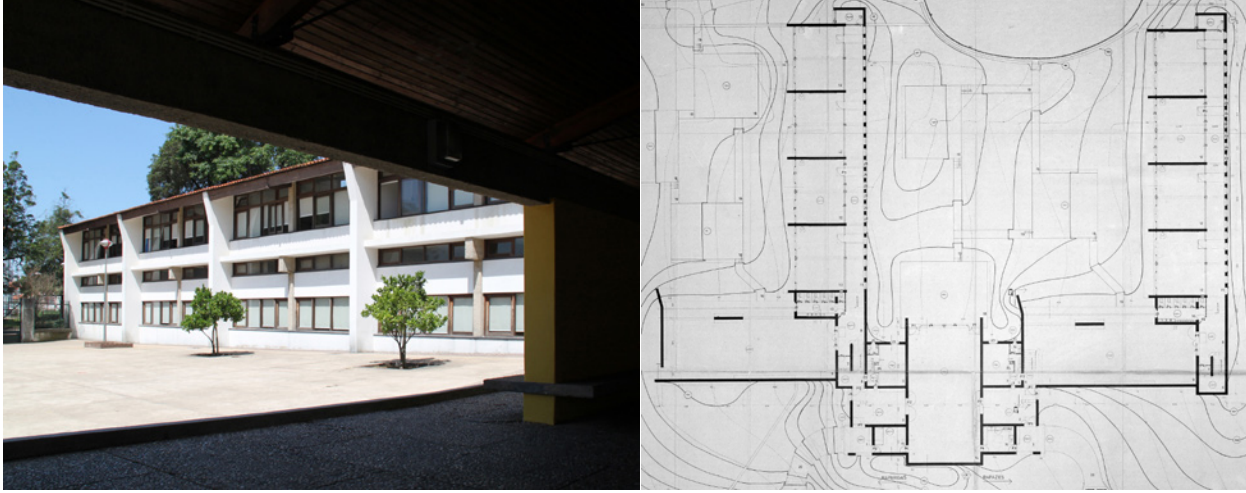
Escola Primária do Cedro en Vila Nova de Gaia (1957-61) a: Fotografía estado actual. b: Plano 1ª planta.
